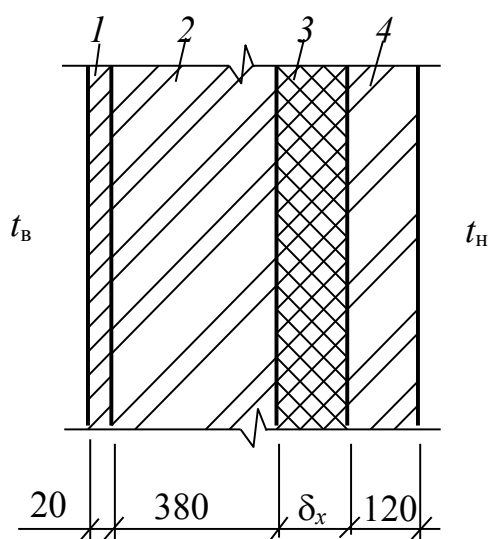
Вариант 1 конструкции наружной стены:
